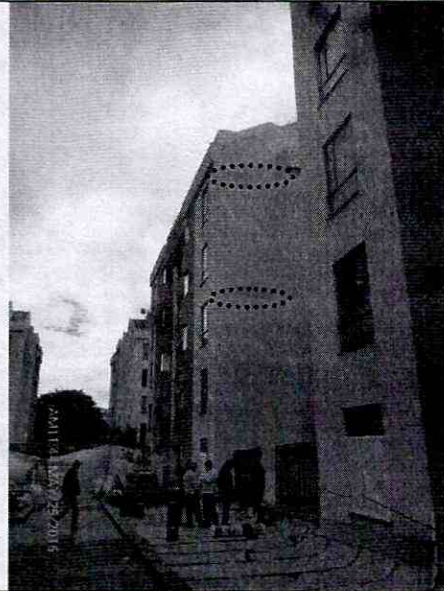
Presencia de grietas y fisuras en los muros de cerramiento de la zona de estacionamiento del Conjunto Residencial La Esperanza I y II P.H. de la Calle 163B No. 45 - 32, en el Sector Catastral Britalia de la Localidad Suba.
